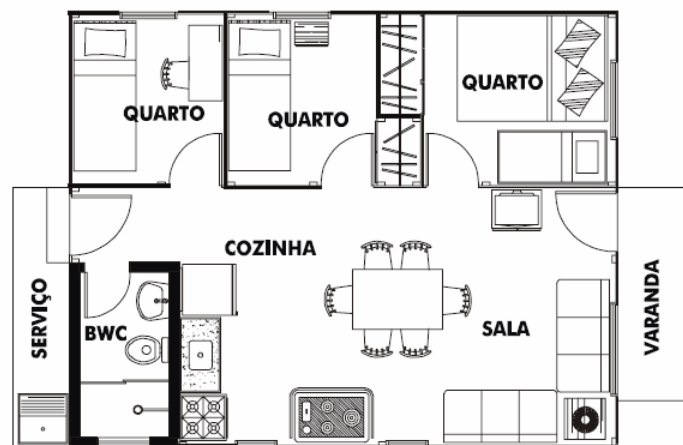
Projeto da casa construída com painéis em madeira. Área = 42m².
